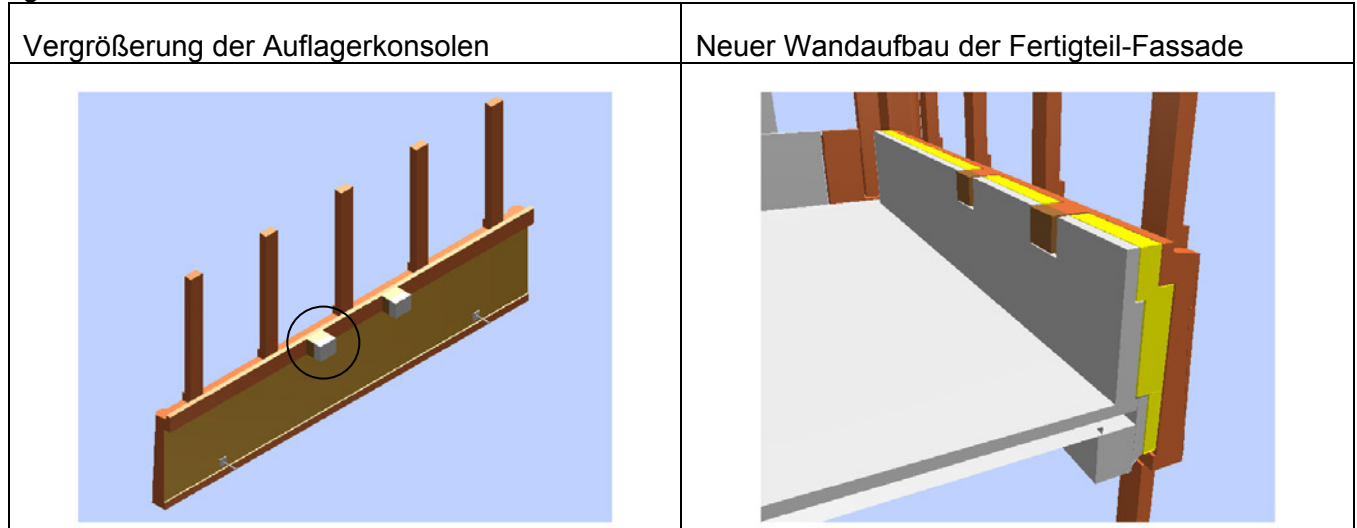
3: 3-D-Modell Brüstungselement mit erweiterter Auflagerkonsole sowie neuem Wandaufbau durch Brüstungsversatz
